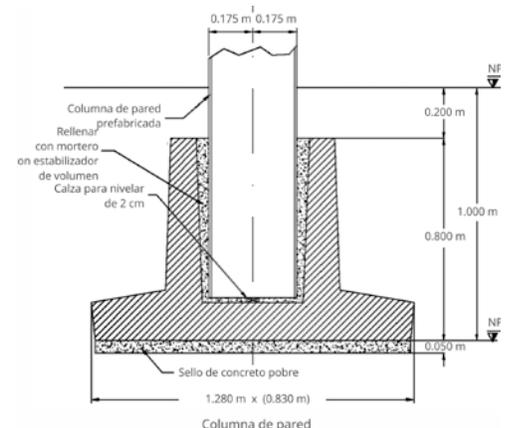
Detalle típico de fundación con placa prefabricada para nave industrial
